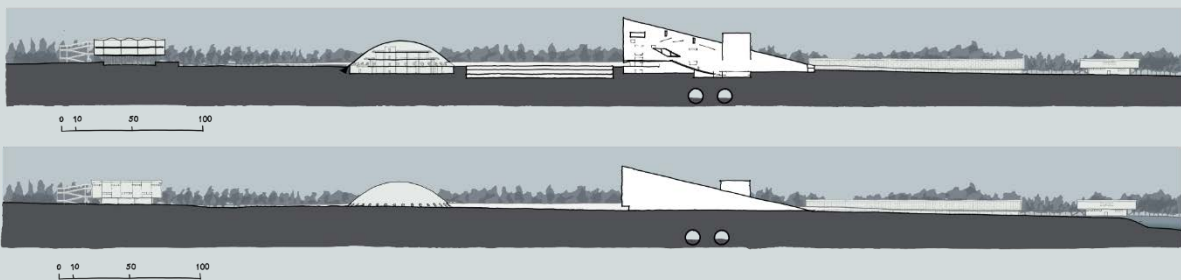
Implantação – 2000 – Versão 06B – desenho nosso.
